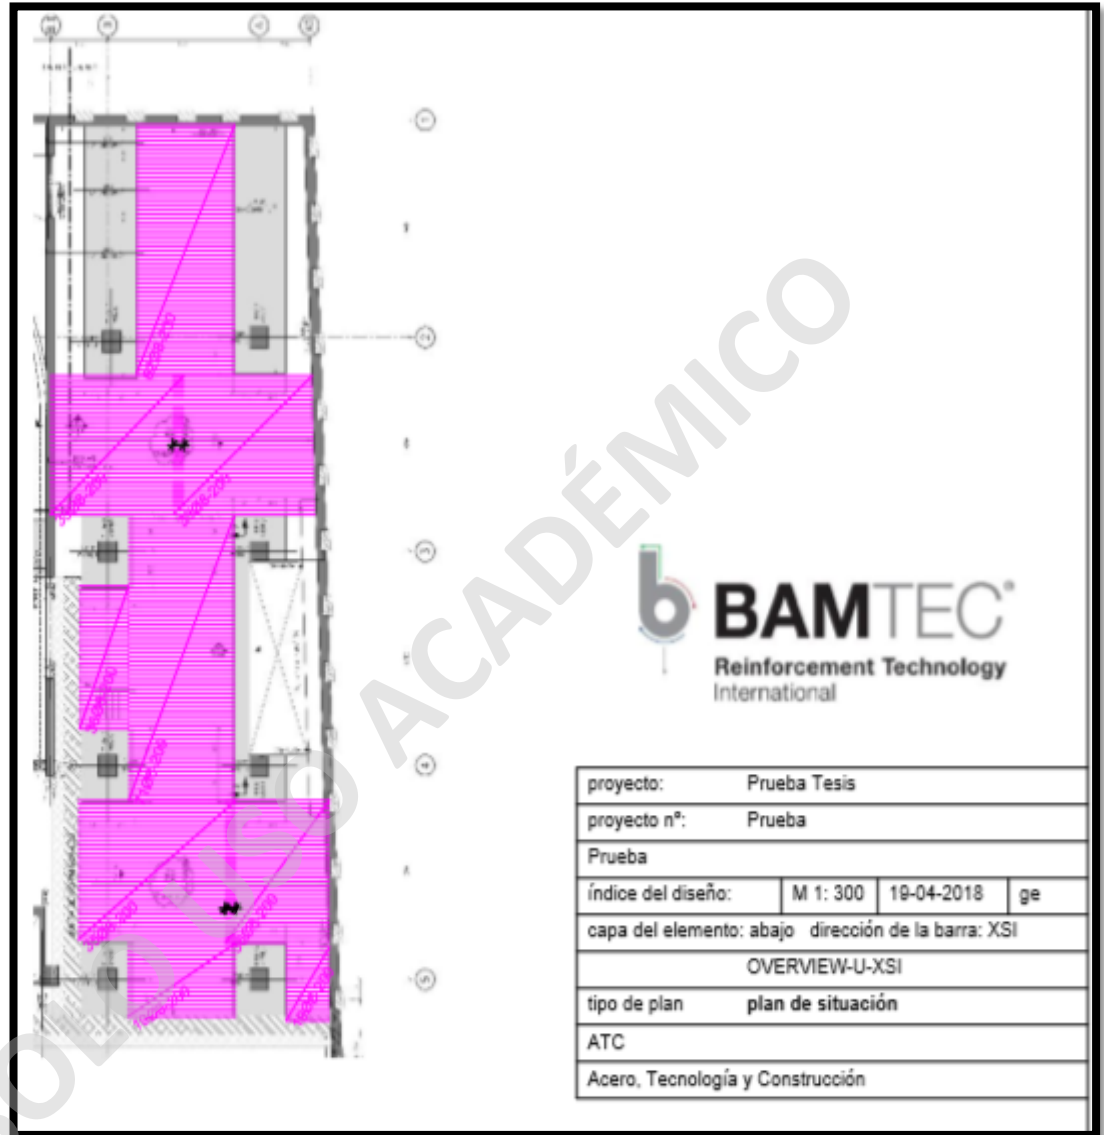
, Plano de fabricación, Fuente: Elaboración propia
